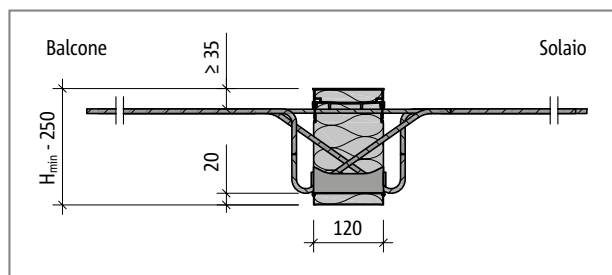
Schöck Isokorb® tipo KXT45-VV: sezione dell'elemento
